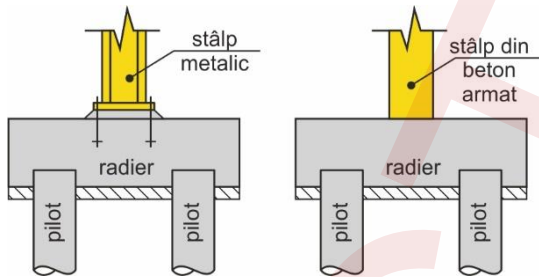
Alcătuirea fundațiilor pe piloți pentru stâlpi metalici și stâlpi din beton armat
